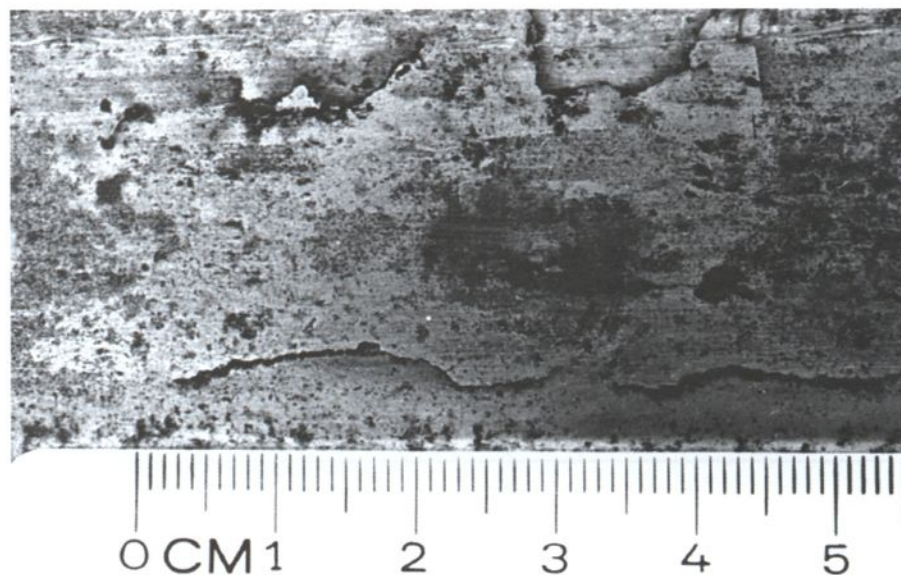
Plan de roulement d'un cœur de voie avec fissures
